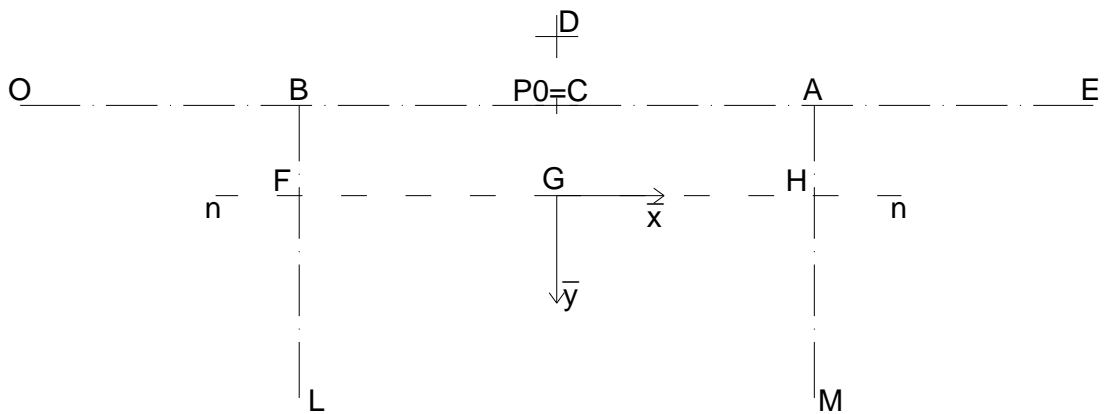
1 - Punti notevoli del calcestruzzo – verifica asse neutro – profilo a π
